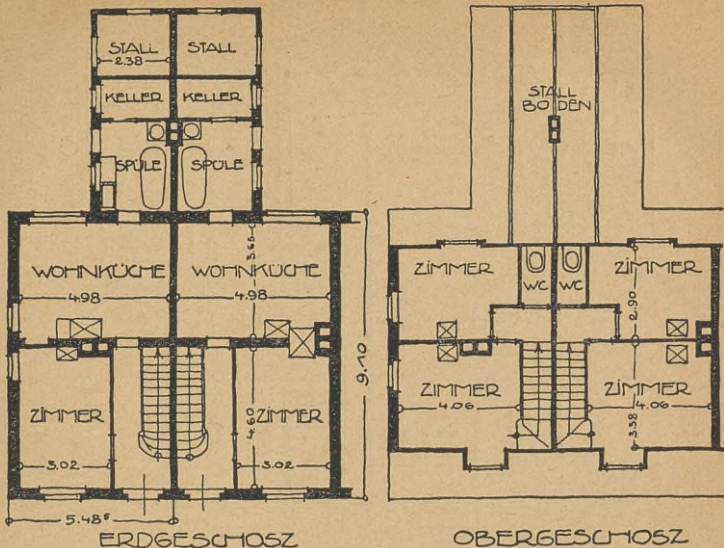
u. 63. Haus aus der Gartenstadt Staaken. Beb. Fläche ohne Stall 49,91 qm. Architekt Schmitthenner
